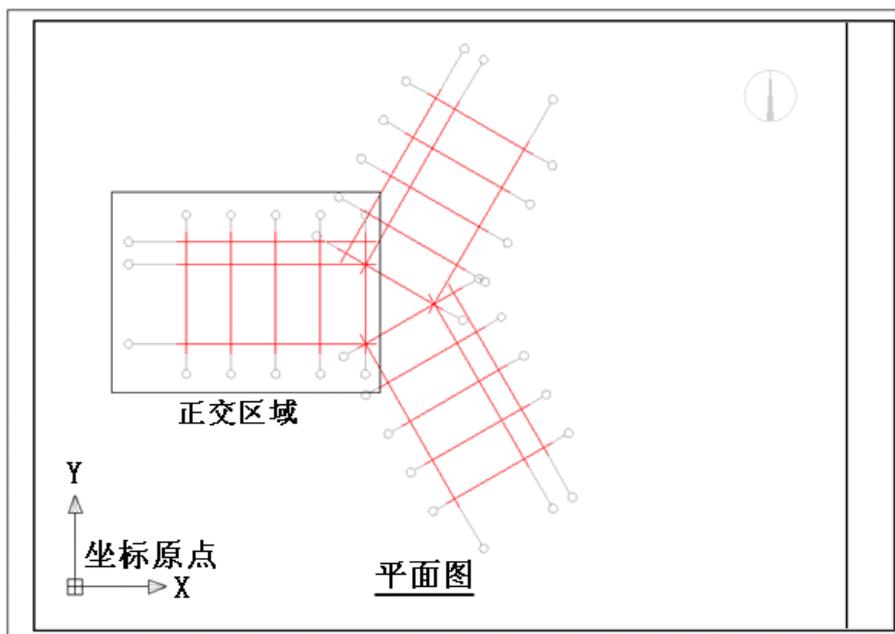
正交区域相互斜交的平面图方向与指北针方向示意
